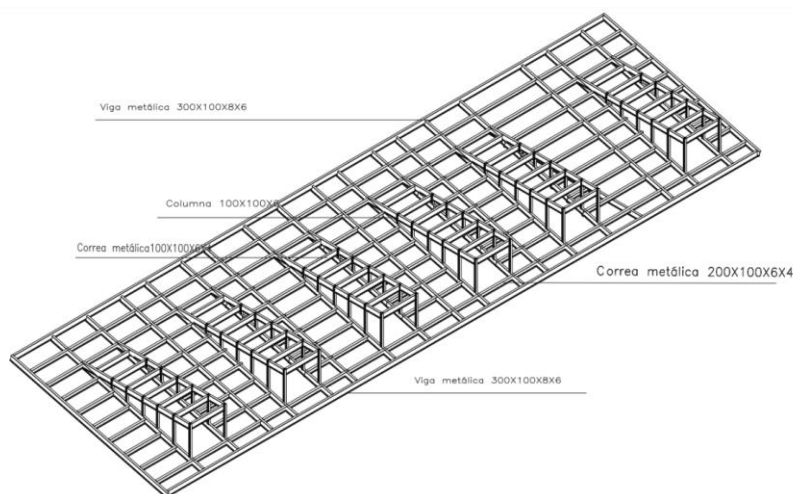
Estructura de cubierta con tragaluces. Elaborado por Nacevilla 2020
